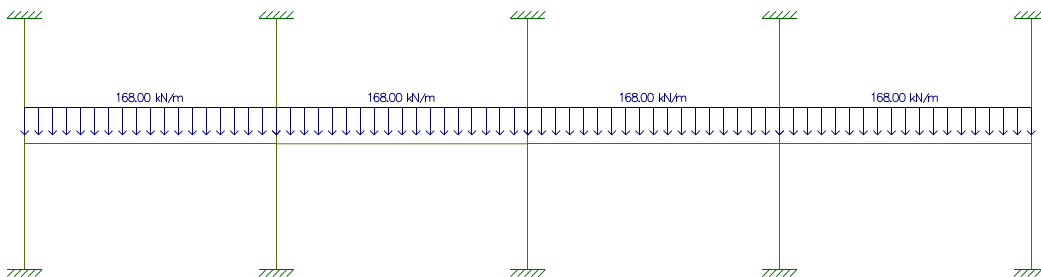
Esquema estrutural usado no MPE – Pórtico 2 e 3
